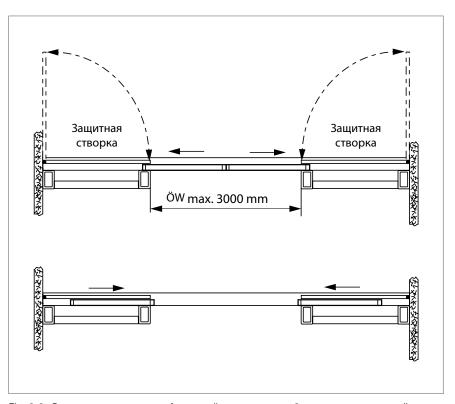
· Вариант установки на фасадной конструкции, 2 створки, с защитной створкой
